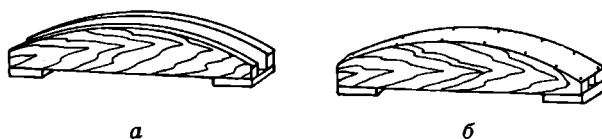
Изготовление опалубки для кладки лучковой перемычки:
